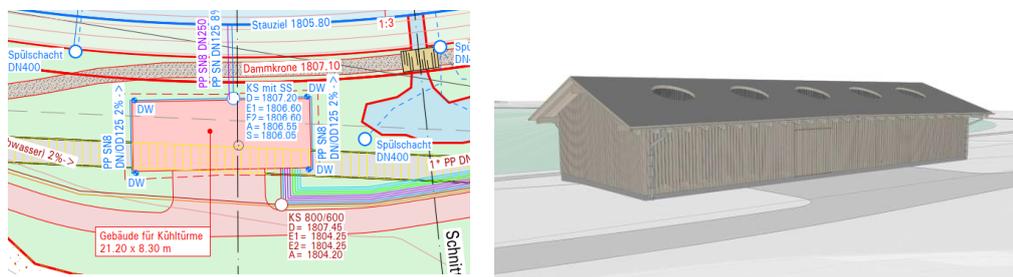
neues Betriebsgebäude für Kühltürme, Ausschnitt Situationsplan Bauprojekt und 3D-Ansicht (Quelle: Steiger Ingenieure + Planer AG, Reichenbach Architekten AG)
